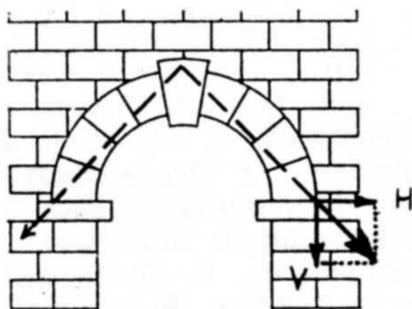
Rundbogen im Mauerwerk mit Auflast und Widerlagern. Schlußstein und Kämpfer betont. H (horizontale Schubkraft), V (vertikale Auflagerkraft).
